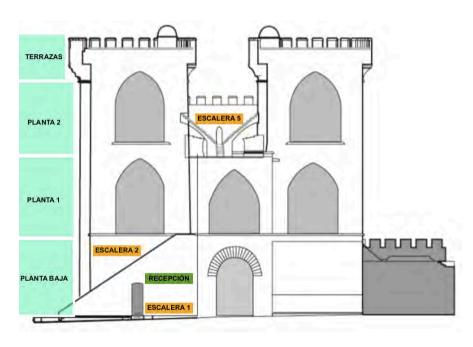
Alzado posterior de las Torres indicando plantas estudiadas y escaleras (Fuente: www.museosymonumentosvalencia.com Plano modificado por el autor)
